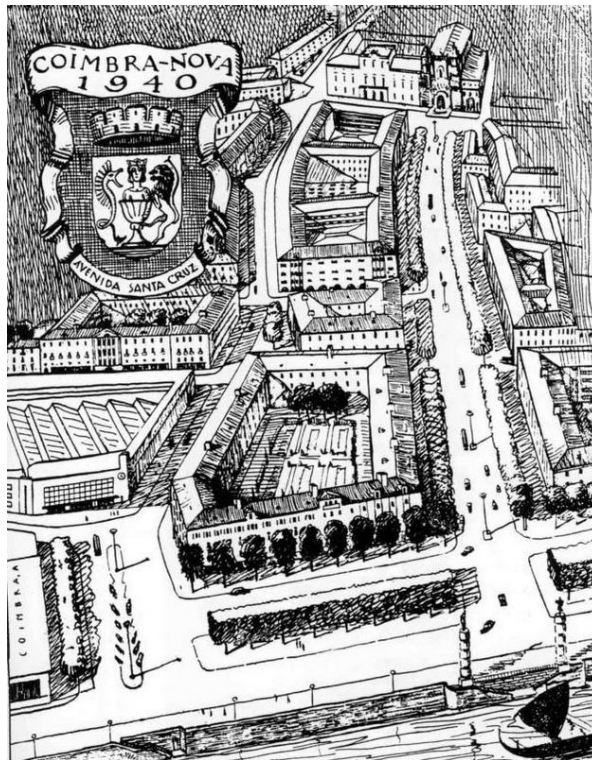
1936 – Plano de urbanização da parte baixa da cidade, de Luís Benavente;¹
